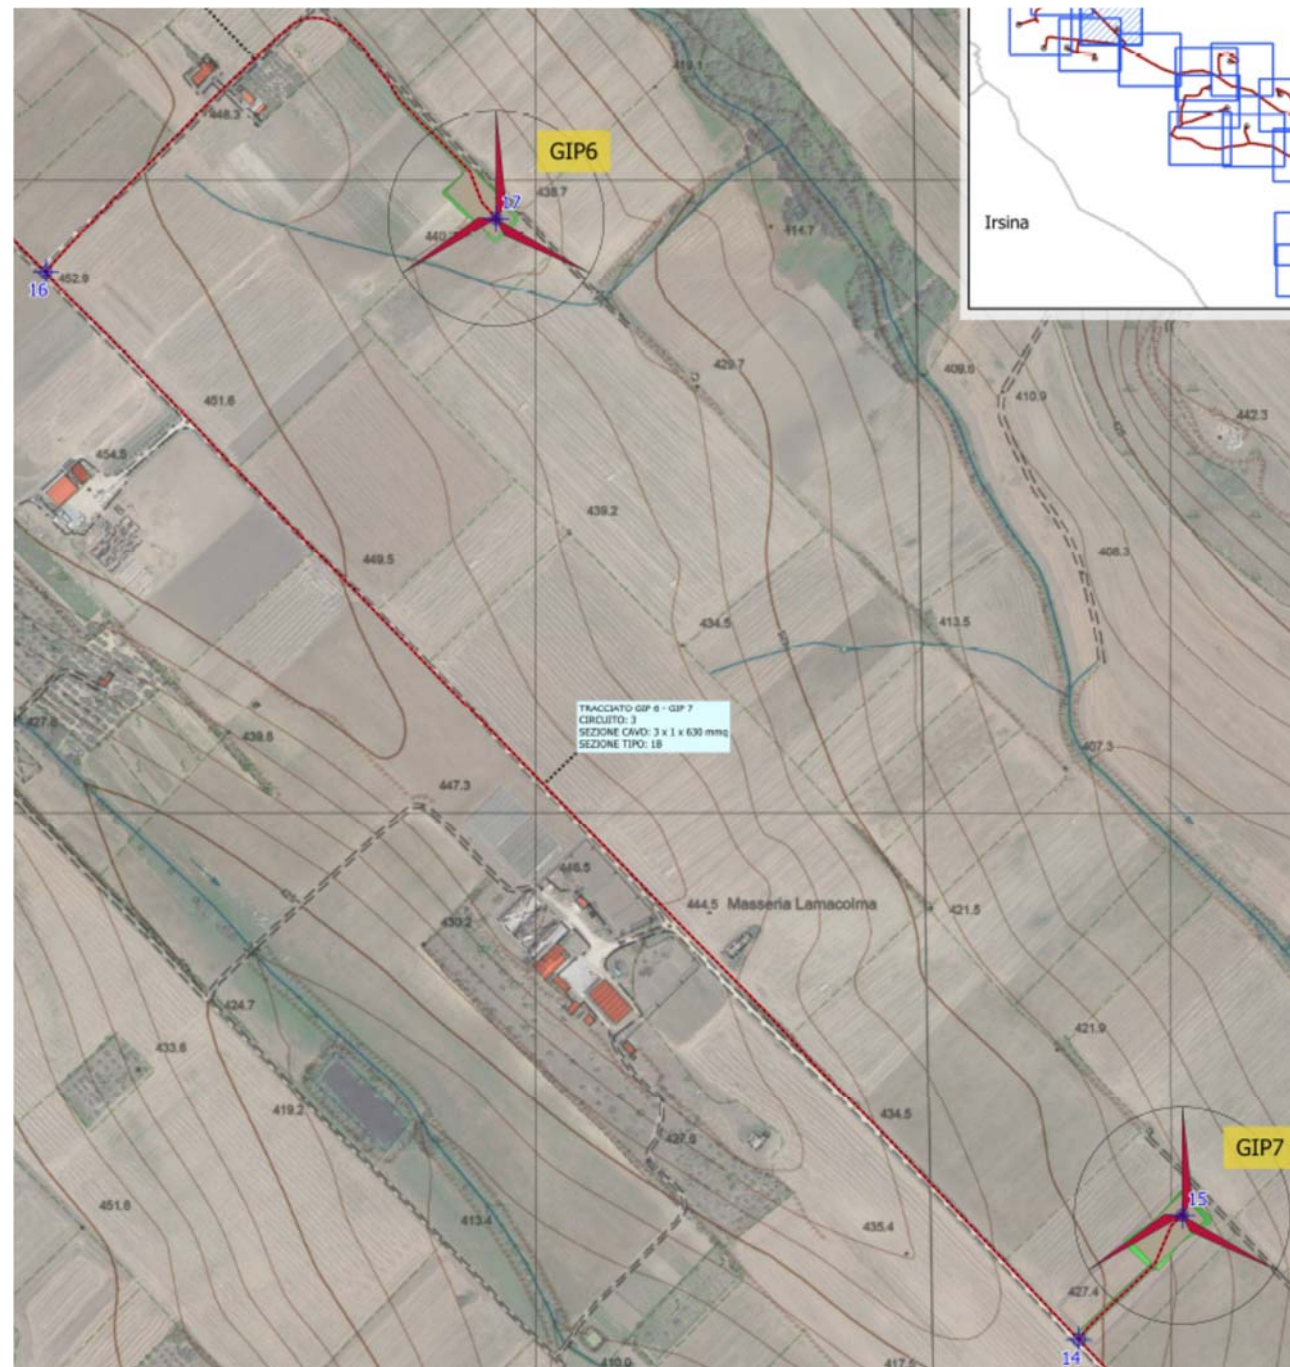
Stralcio planimetria con tracciato elettrodotto (F0433AT13B) – Layout originario
